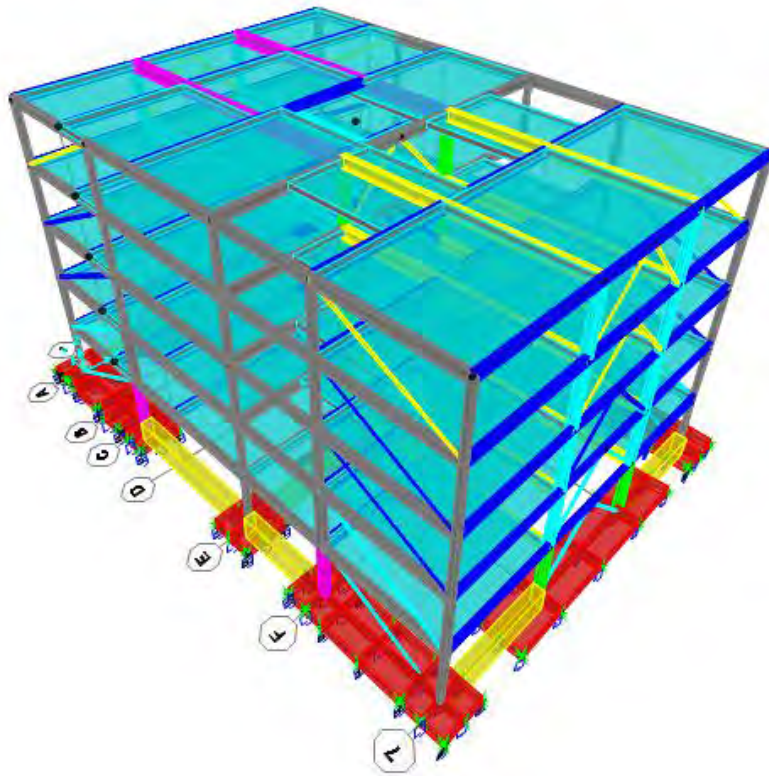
Cimentación reforzada mediante c/ vigas de cimentación.
